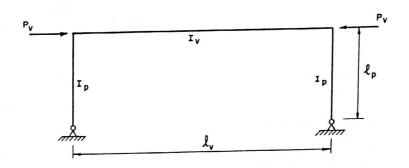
PÓRTICO BI-ARTICULADO COM PROTENSÃO SÓ NA VIGA
